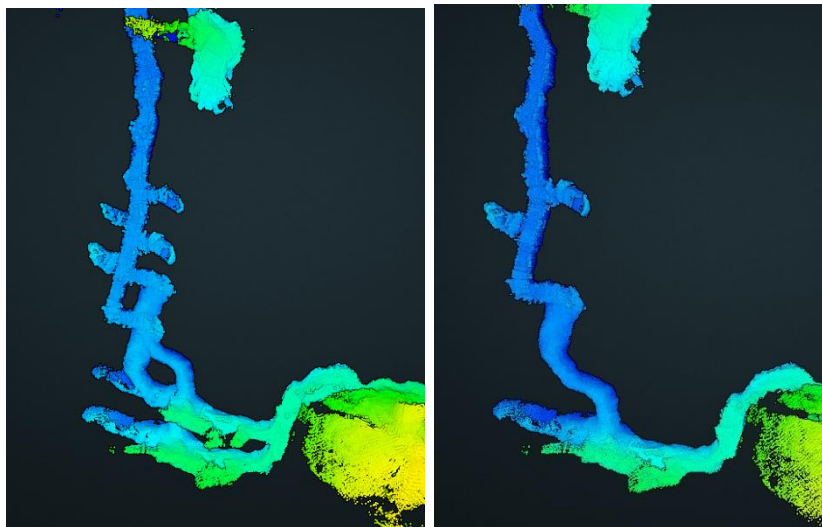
ZEB-Revo Go měření odvodňovací štolý před opravou
